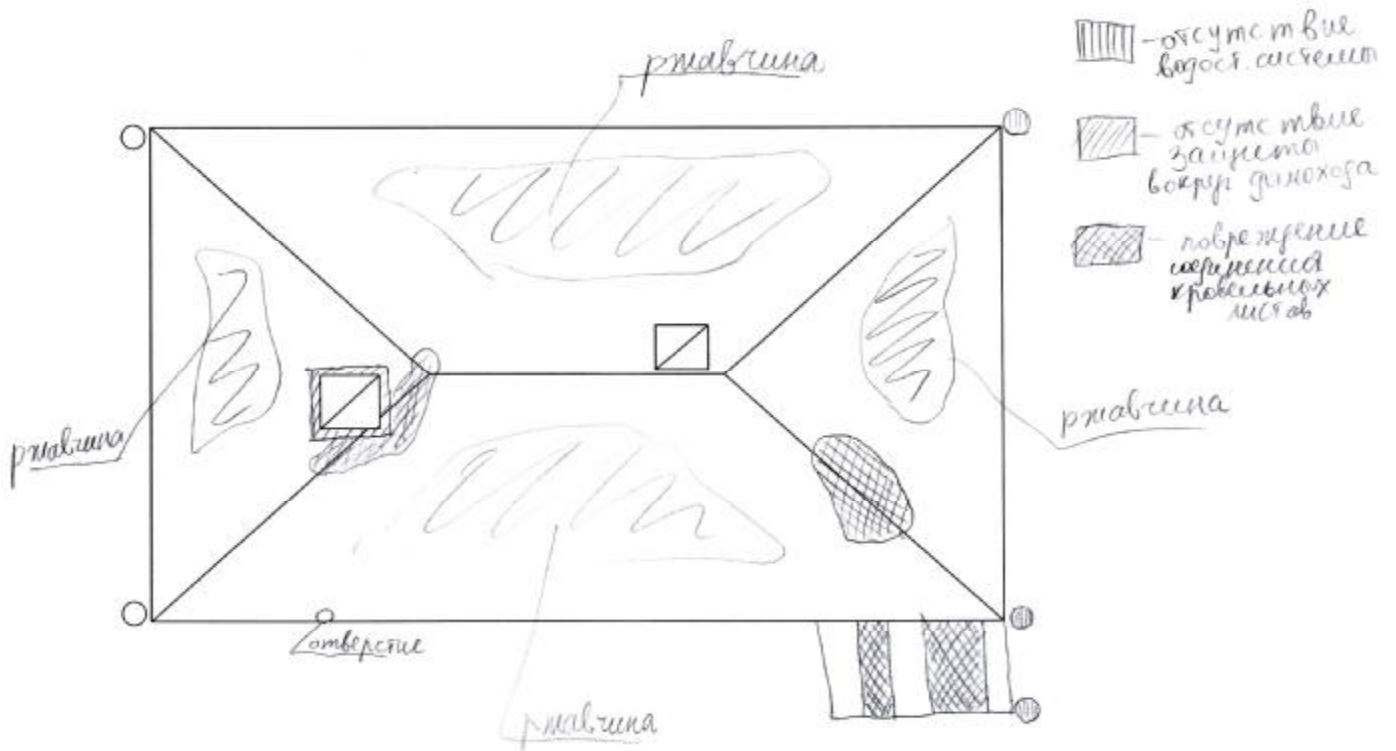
Дефектная карта кровли (здание рис.1,2).
